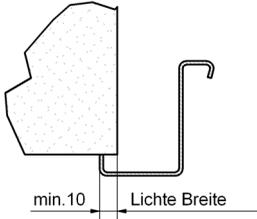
Mindestübergriff der Eckzargenspiegel (Mauerwerk, Beton- und Porenbetonwand)
